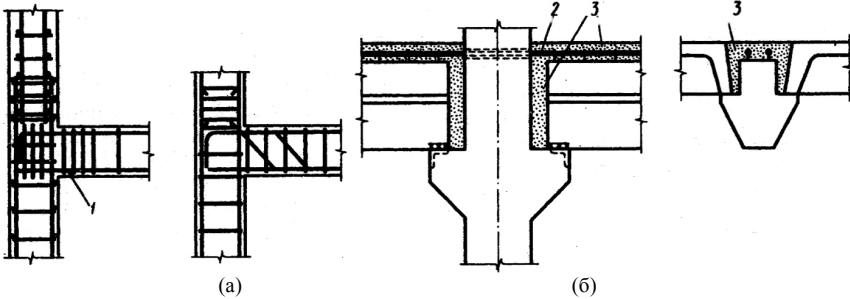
Вузли стикування ригелів із стояками складних залізобетонних рам каркасних будівель: (а) – монолітний; (б) – збірний;
